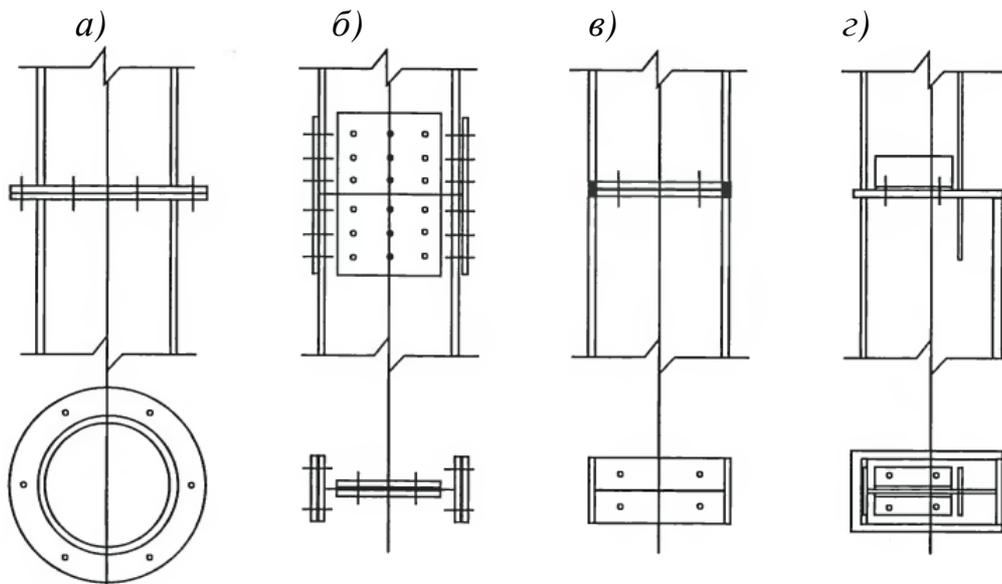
Монтажные узлы стыков стальных колонн различного поперечного сечения на высокопрочных болтах: а, в – на фланцевых соединениях; б – с накладками; г – при изменении поперечного сечения элементов колонны по высоте
